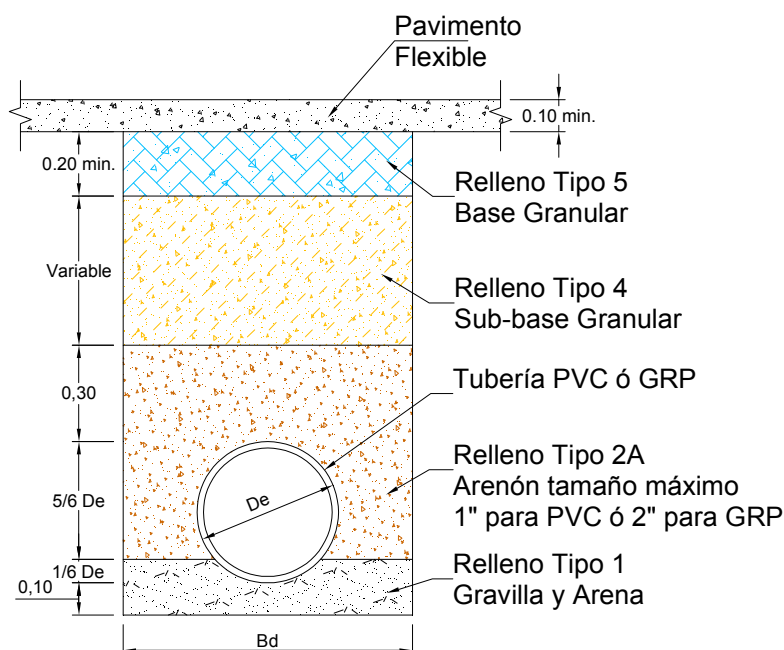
Cimentación Típica de tubería para Vías de Pavimento Flexible
